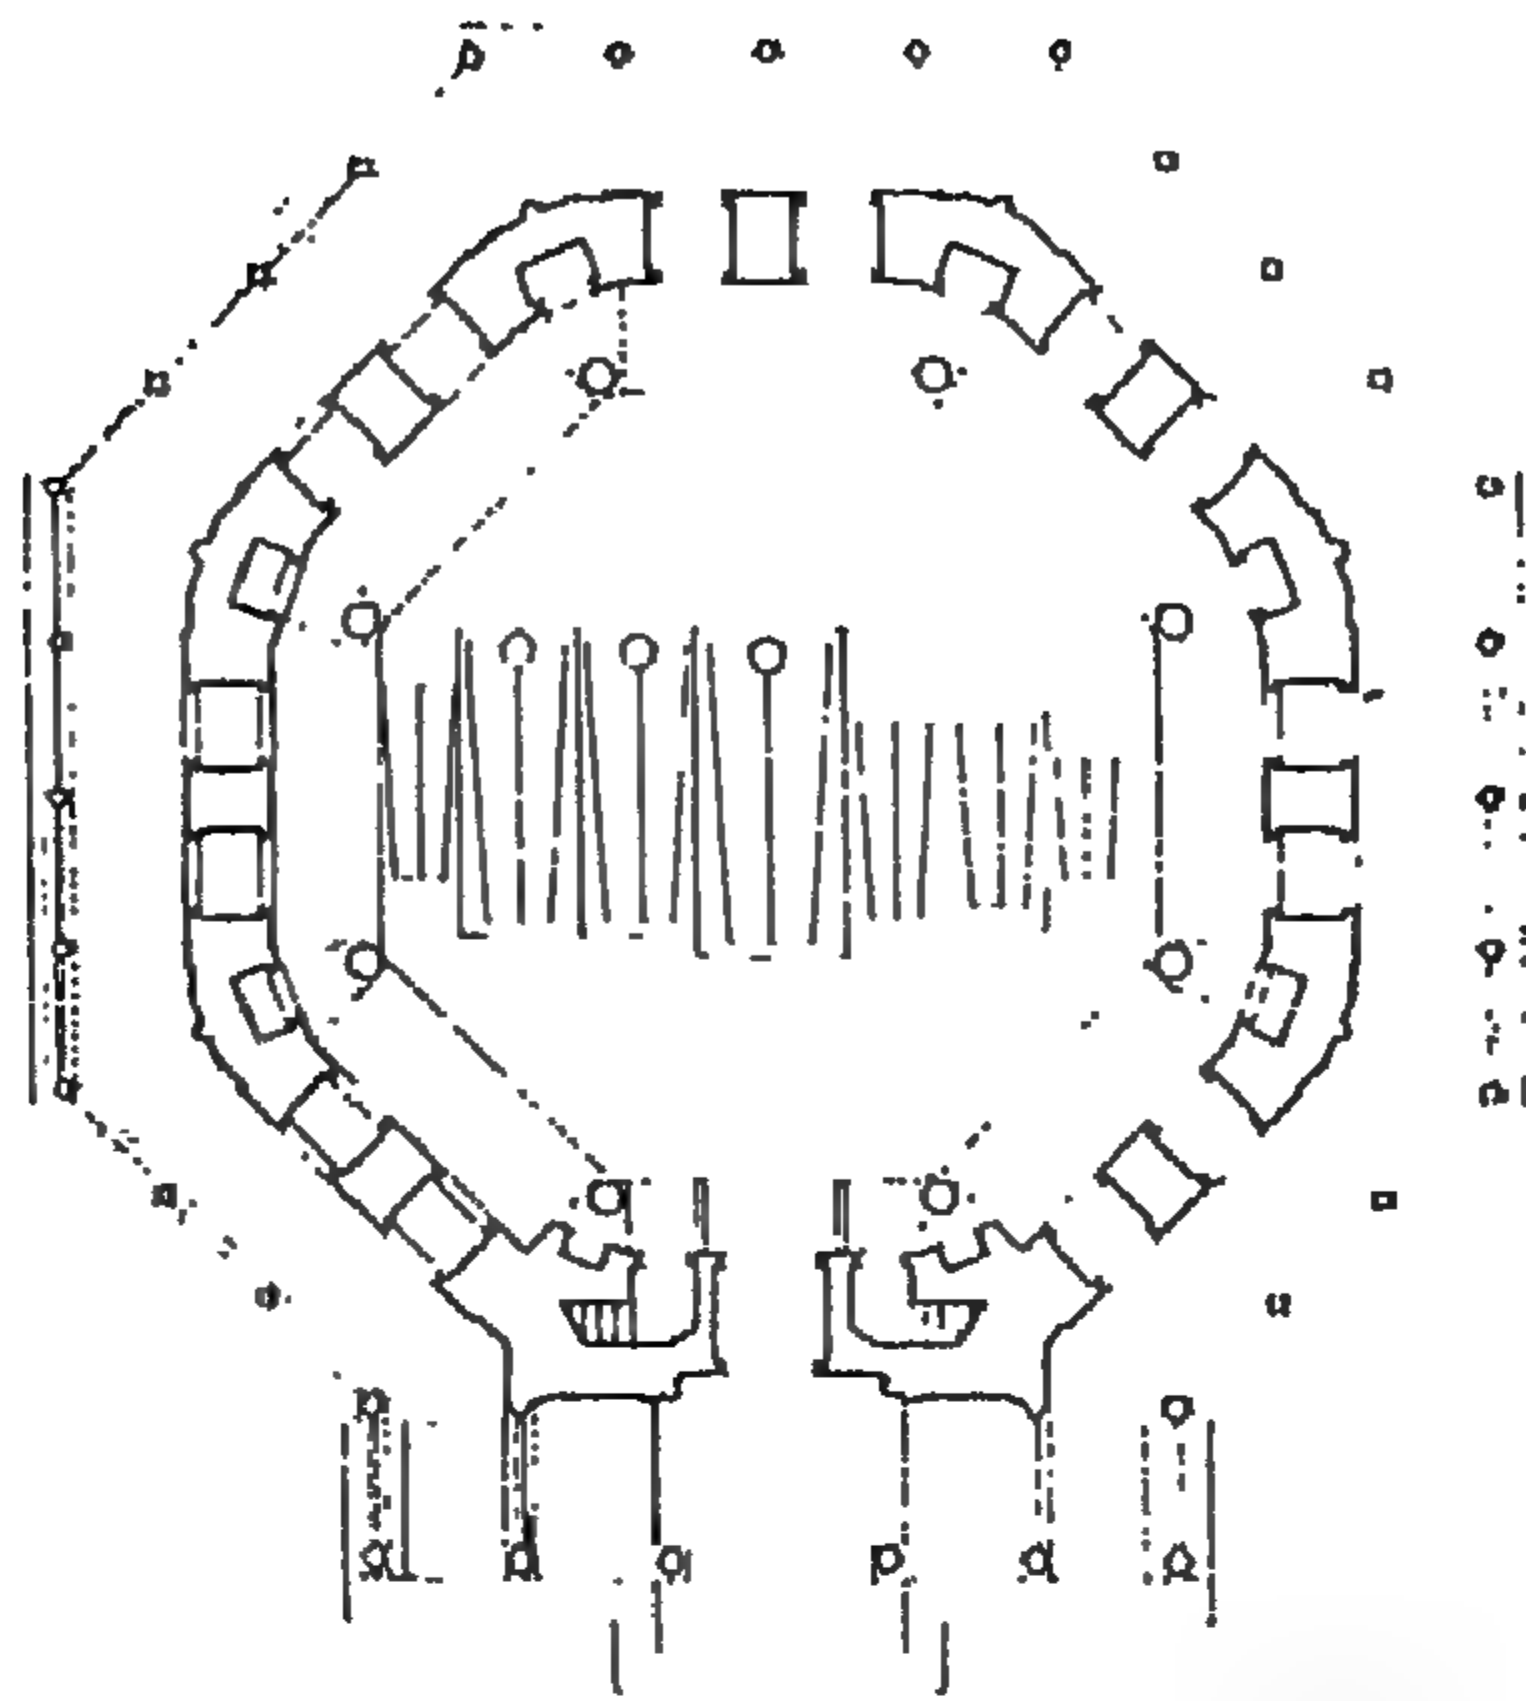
مسقط أفقى لتربة حاجى سلطان فى بورصة (عن : Wilde) .
